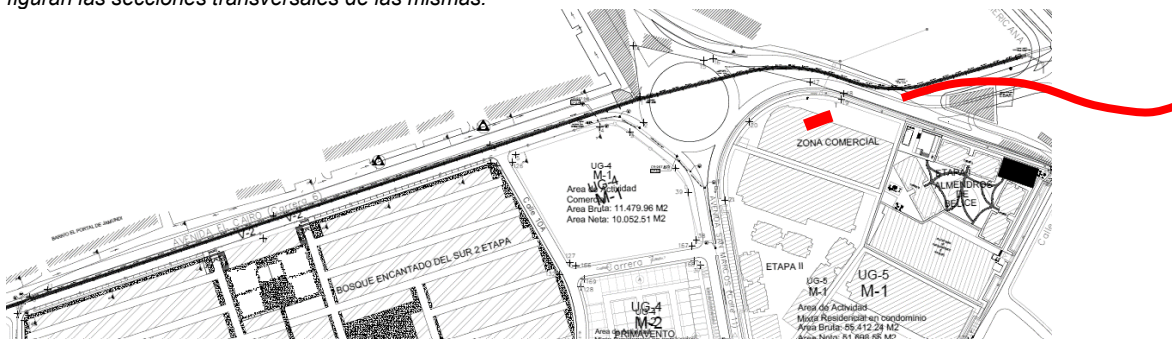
Ubicación de Box Culvert en el Canal Norte. No existe sustento estructural e hidráulico para estas obras.
